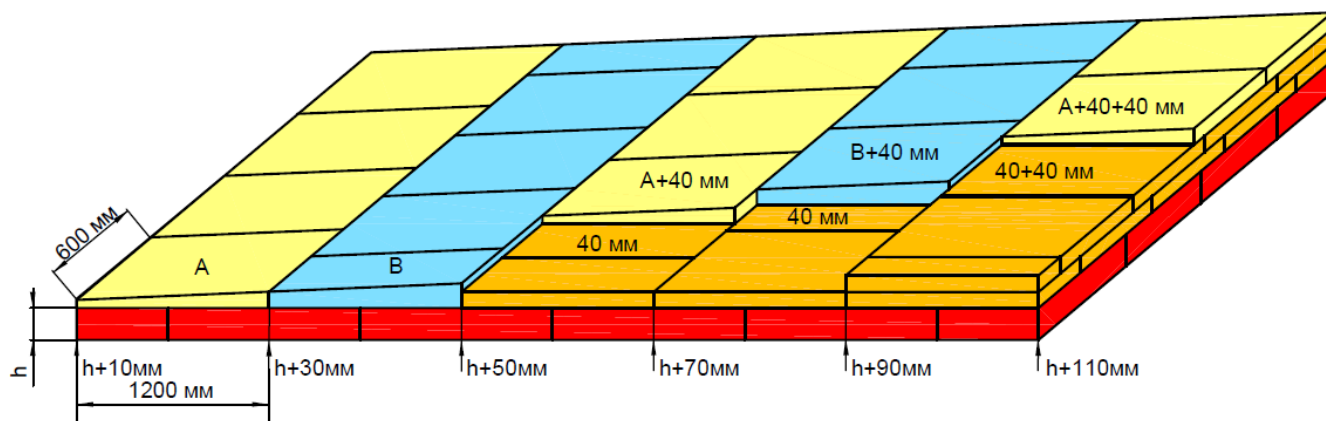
Пример выполнения основного уклона из плит PIR SLOPE 1,7%
